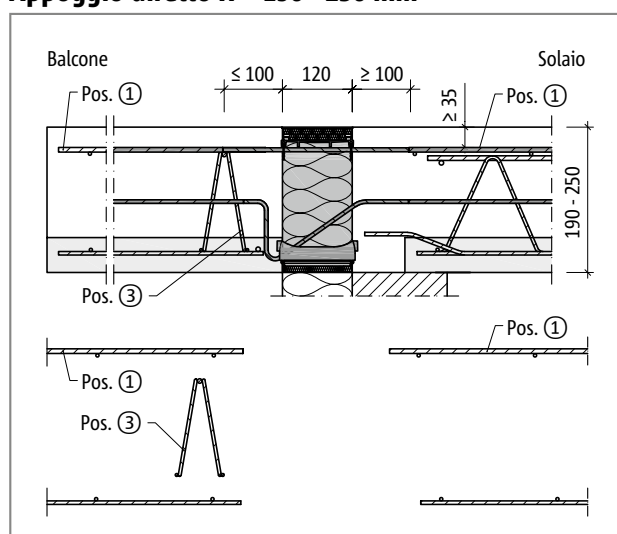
Schöck Isokorb® XT tipo KL-F: armatura in opera con spessore del balcone $h = 190 - 250$ mm con reticolo di supporto
